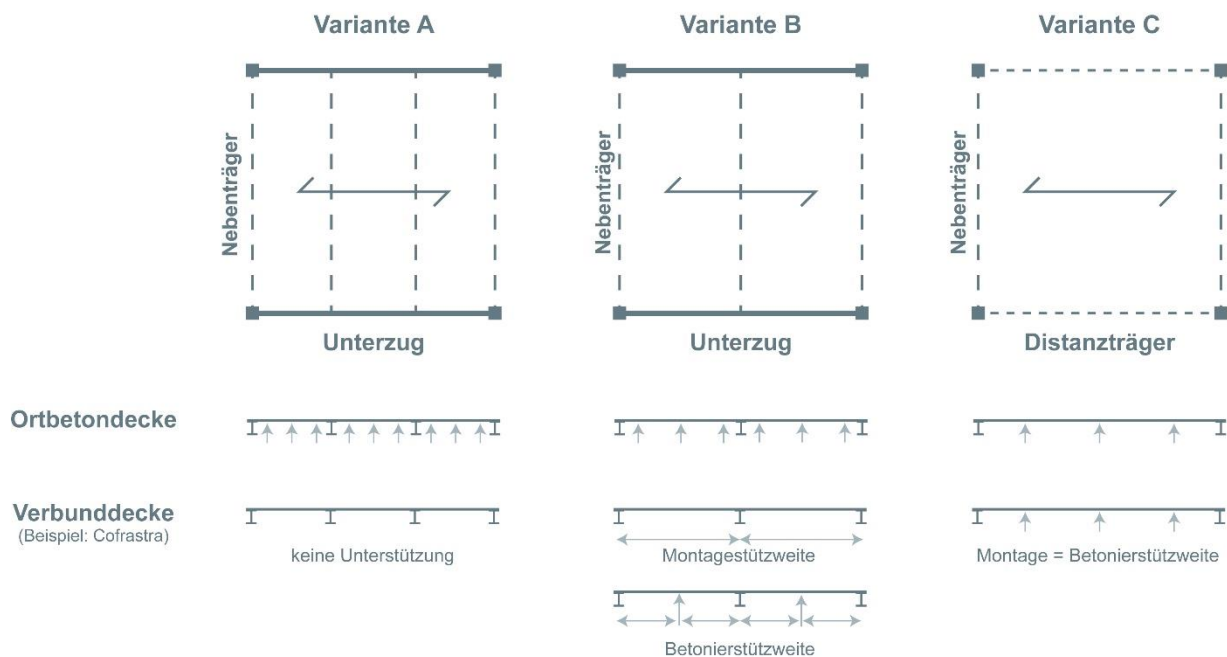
Deckensystem, Trägerabstände und Bauablauf
